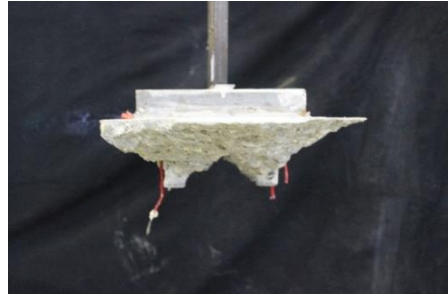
Betonausbruchkörper in der Draufsicht – B3-N
